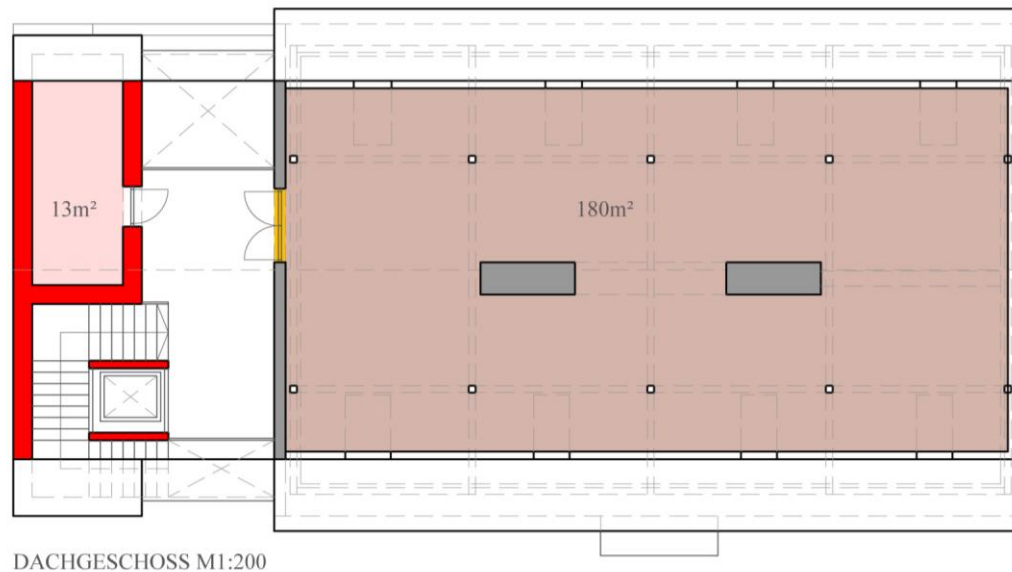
Grundriss Dachgeschoß, Nutzungskonzept Pfarrhaus Winden am See.
